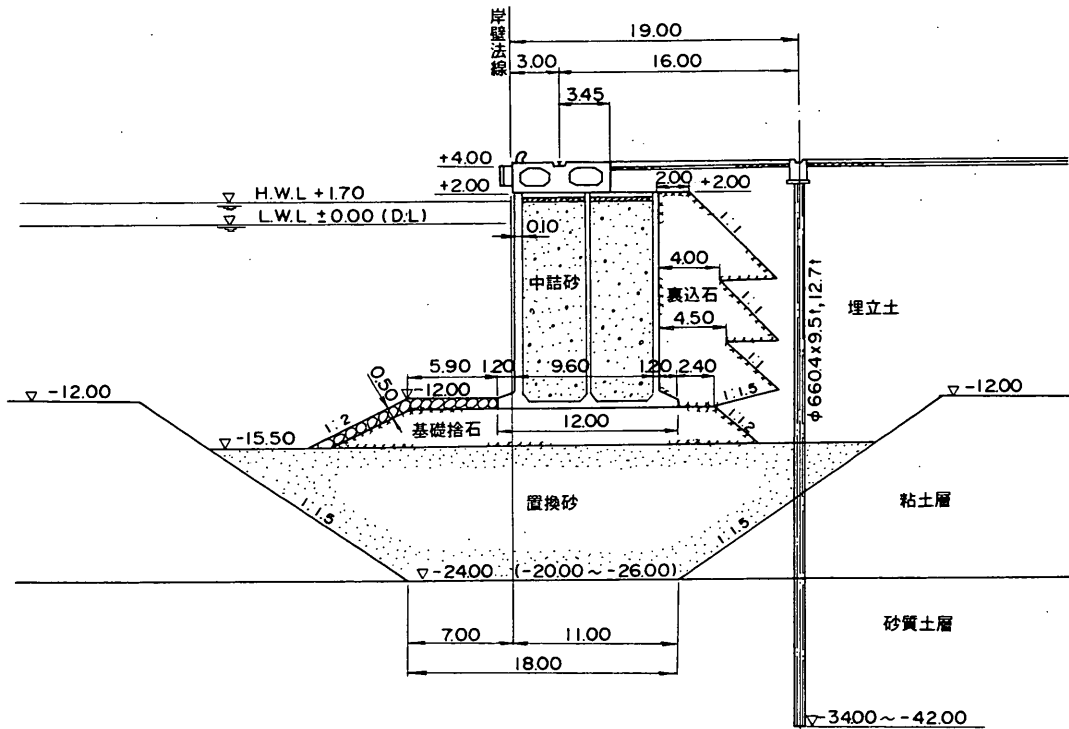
陸脚の基礎が鋼管杭の標準断面図 (PC 1~9)
